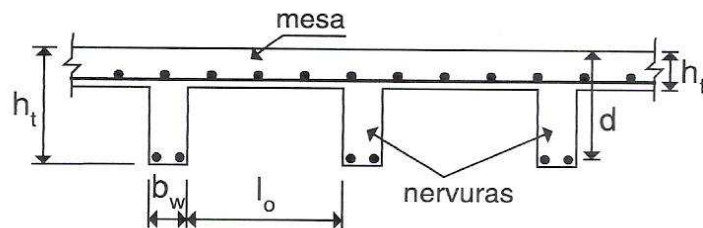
laje nervurada com nervuras aparentes (ARAÚJO, 2003b, p. 144)
